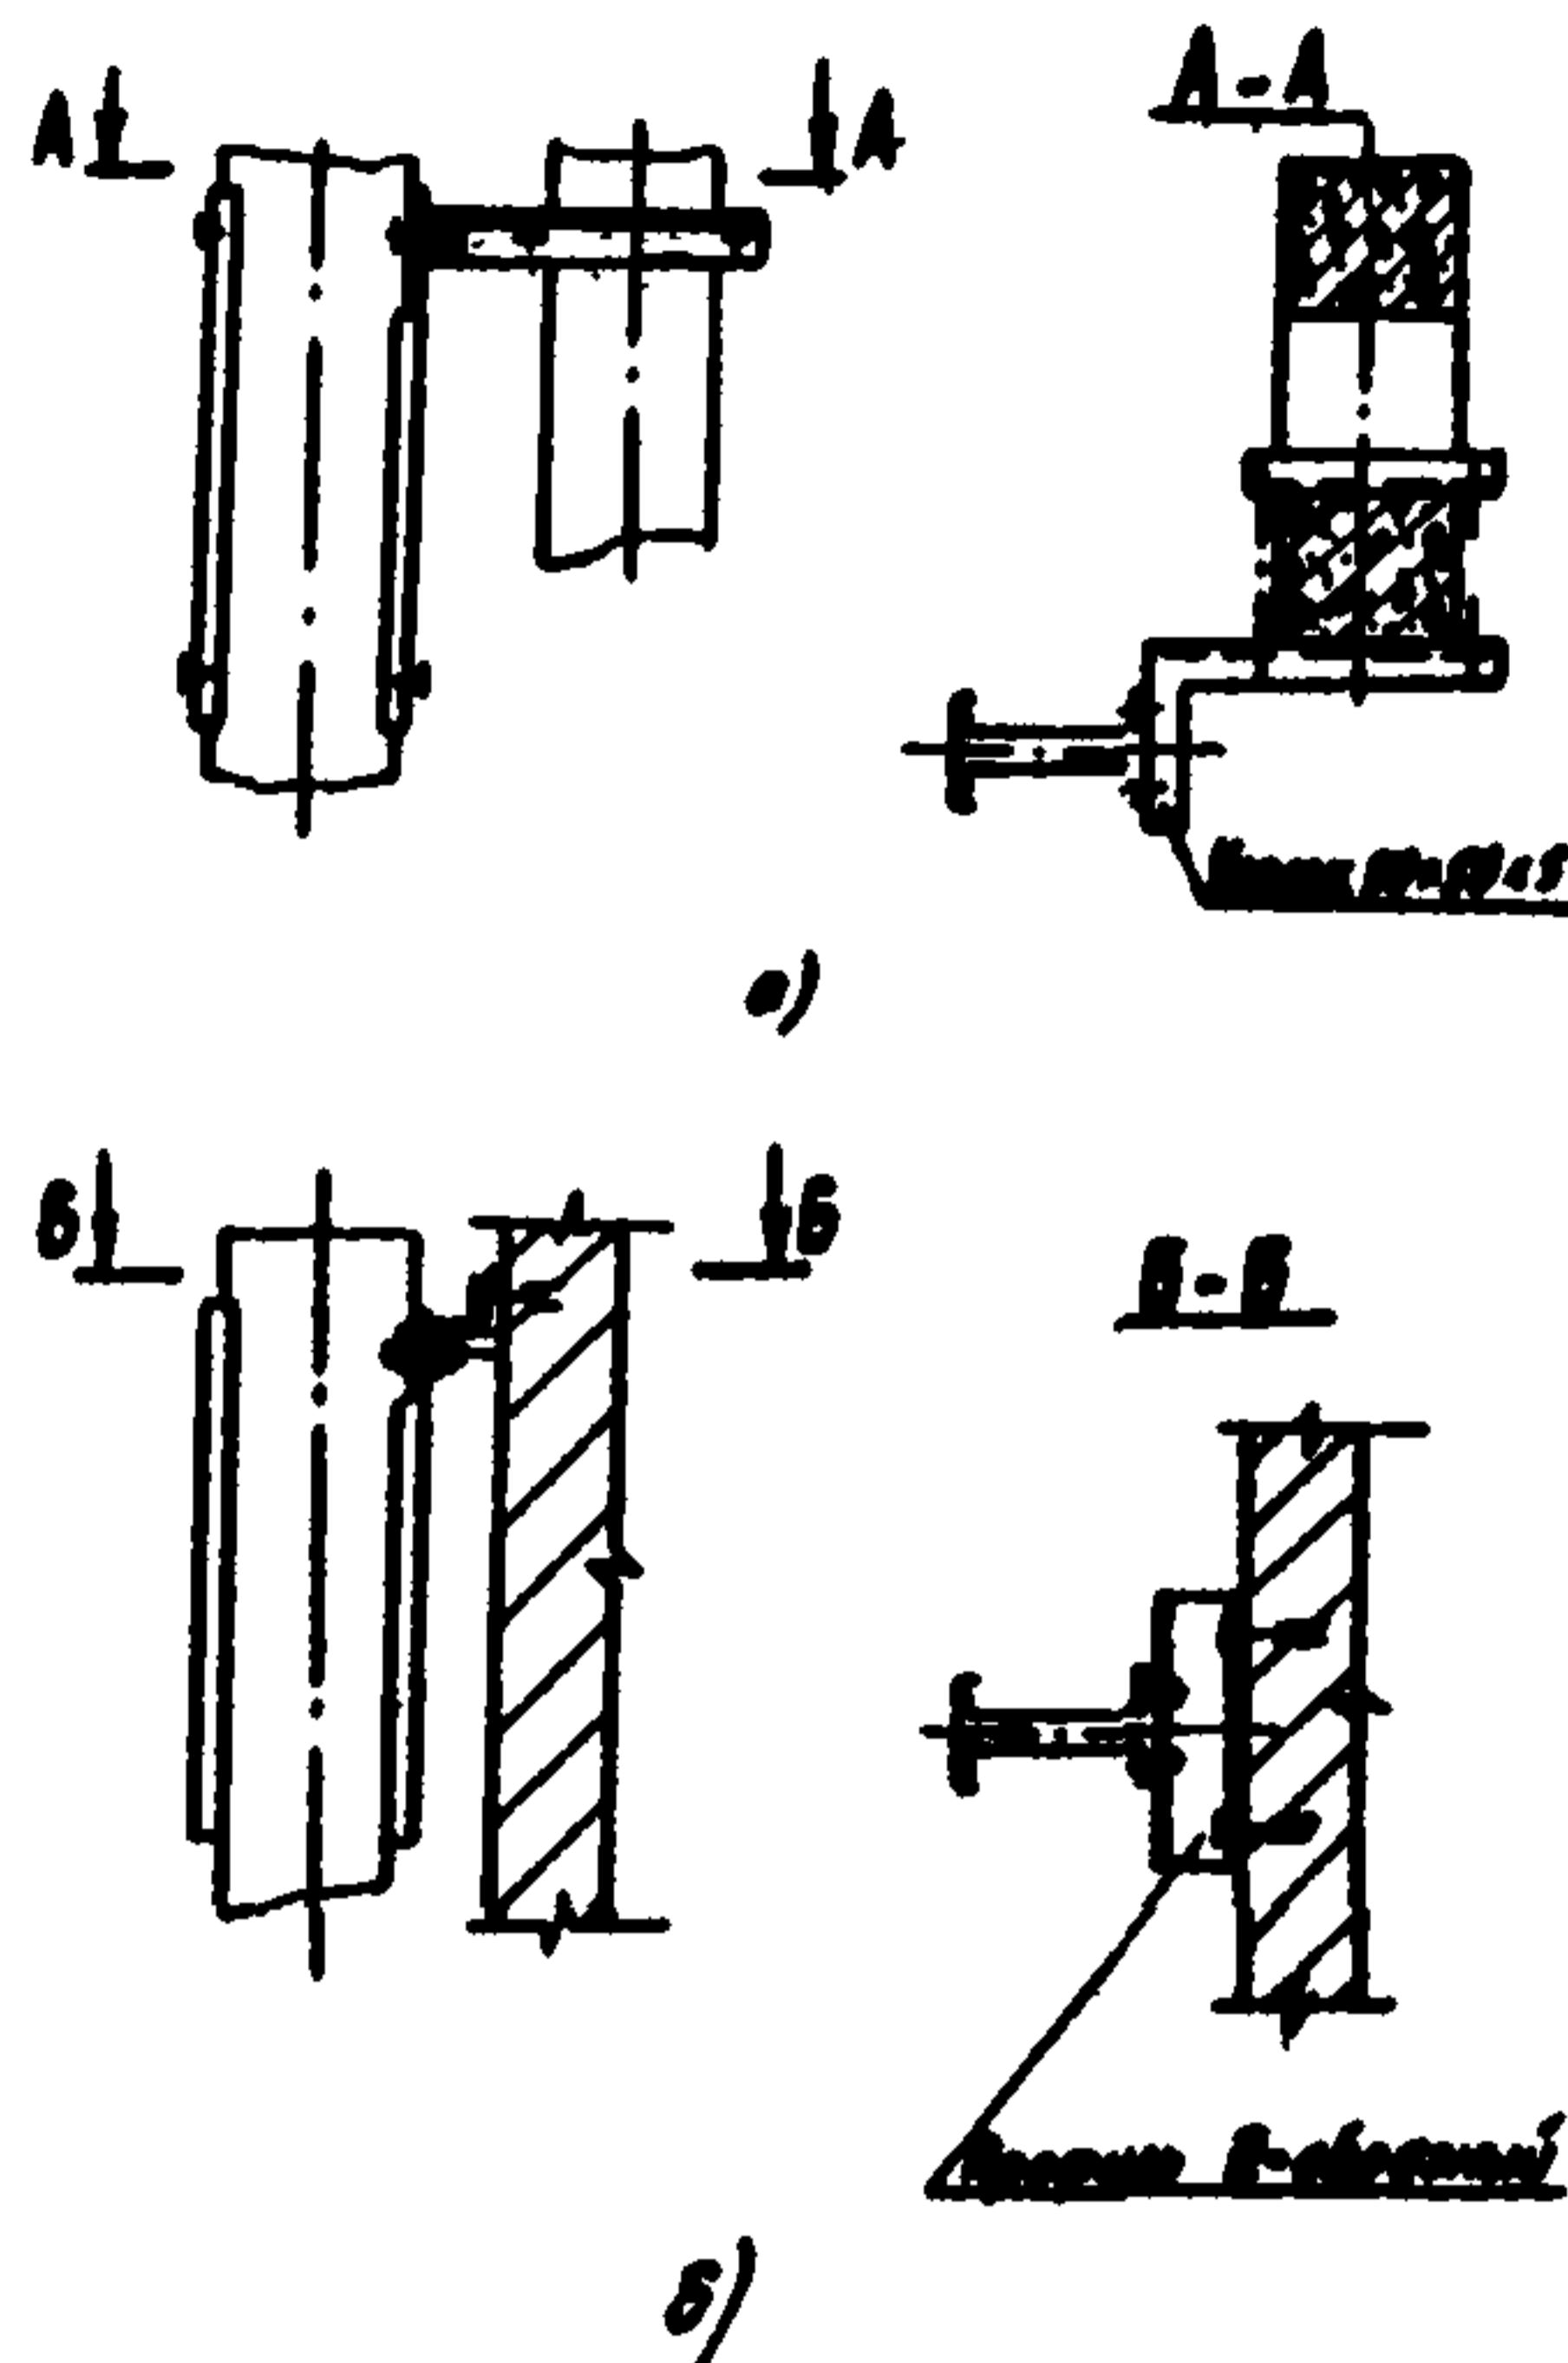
Крепление вертикальных участков шинопровода ШМА4 на 1250 и 1600 А при его положении к стене (колонне) узкой стороной:
